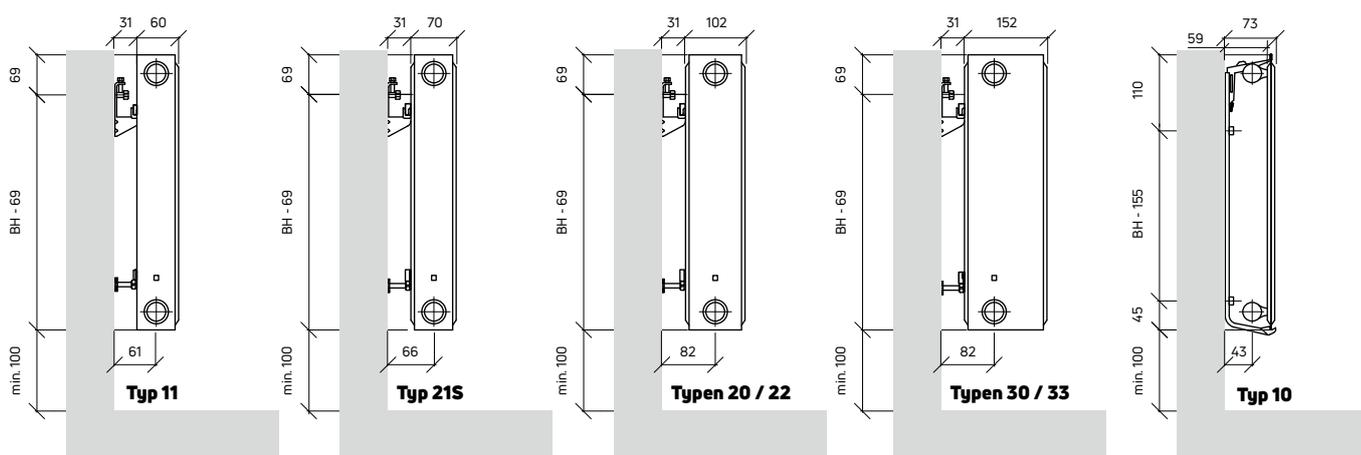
Montage Maße für Compact mit Befestigungslaschen
